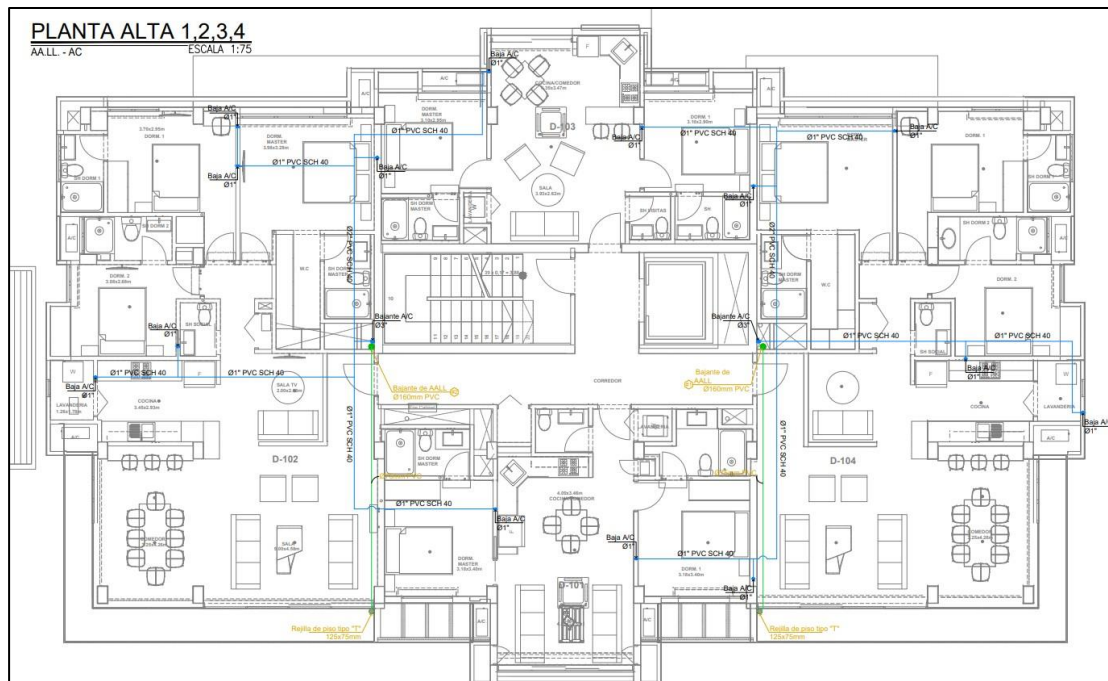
Plano de AALL y AC de Planta Alta 1,2,3,4
